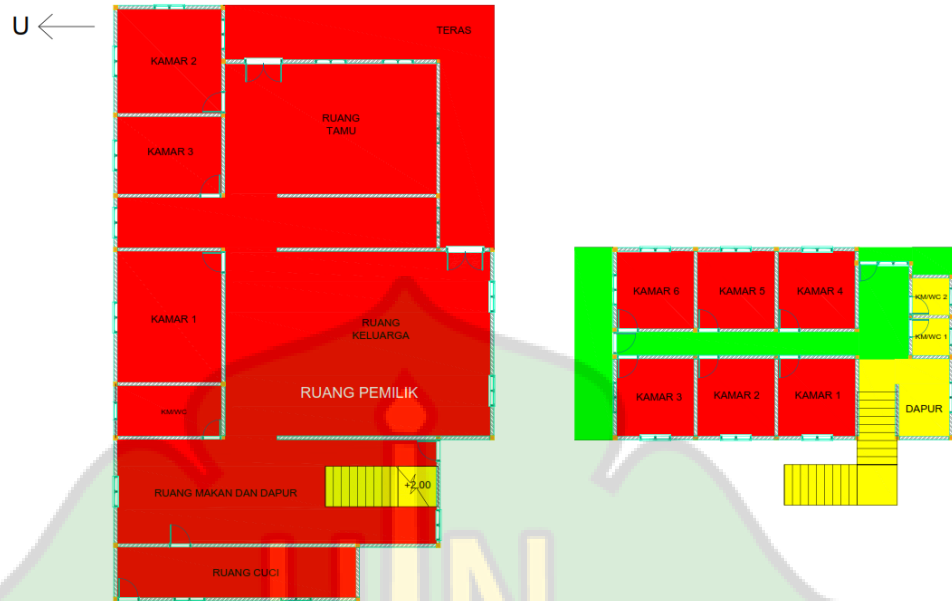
Pemisahan Zona Objek K4 pada Lantai 1 dan Lantai 2
